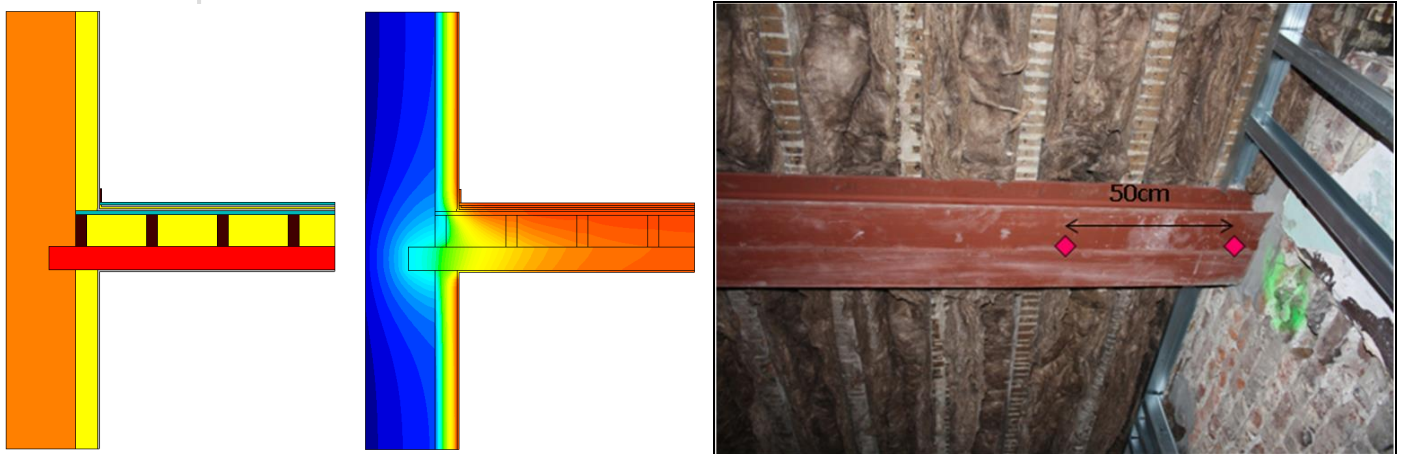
Illustration du nœud 999 formé par l'encastrement d'une double poutre métallique structurale (soutien de plancher intérieur) dans un mur existant isolé par l'intérieur.
